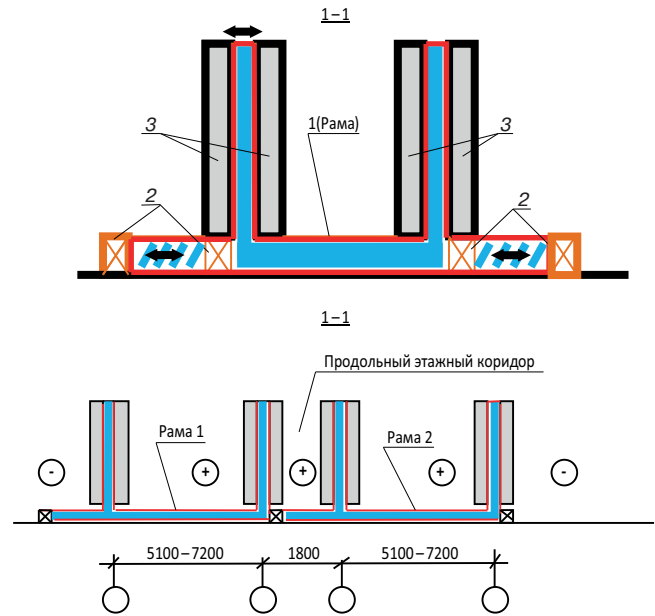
Стапель шириной на блок-секцию – две квартиры в поперечном сечении: 1 – поперечная рама стапеля; 2 – продольные борта плит этажного диска перекрытия; 3 – щитовая опалубка стен объемного блока
